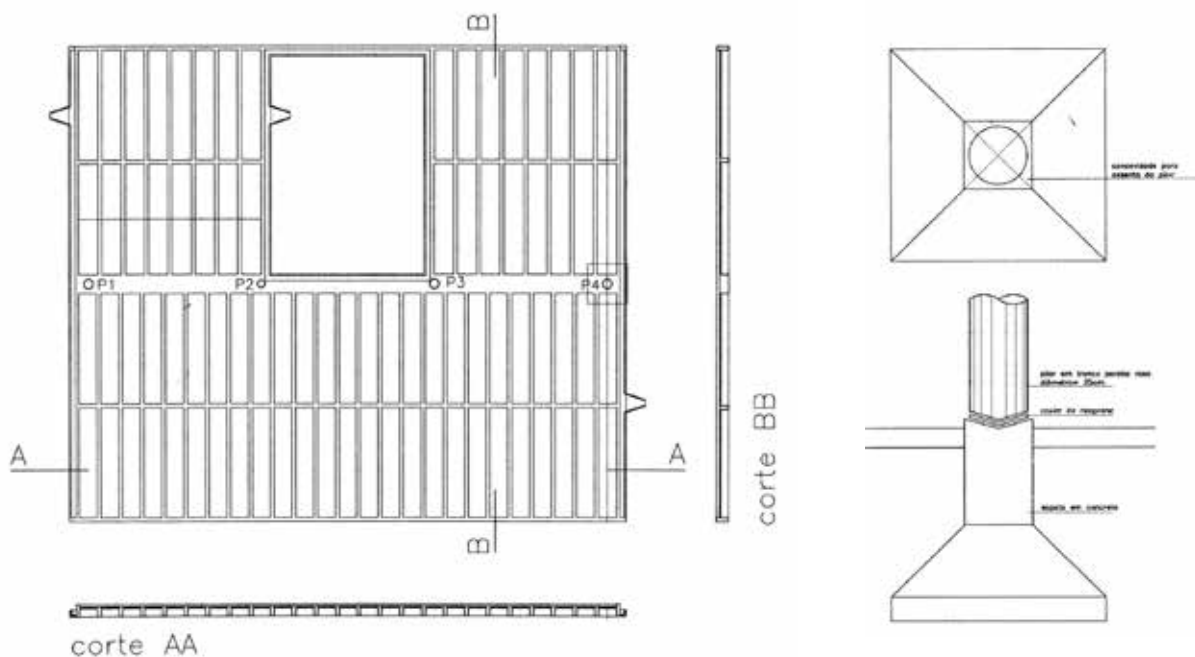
projeto estrutural da laje de cobertura Casa Giocondo Artigas, Reparar na viga chata central, apoiada por quatro pilares (P1, P2, P3 e P4). Os dois pilares centrais, P2 e P3 são em tronco de madeira peroba rosa. As bordas laterais da laje apóiam-se sobre muro de divisa em alvenaria de tijolos maciços.
